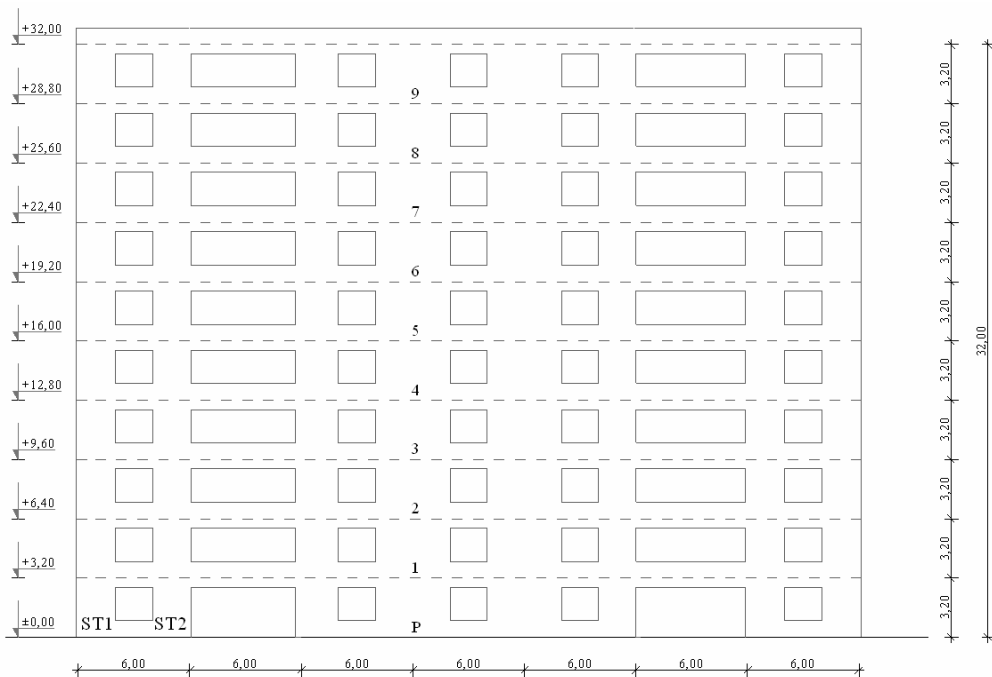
Okvir H3, dispozicija gred in stebrov, skeletna konstrukcija
